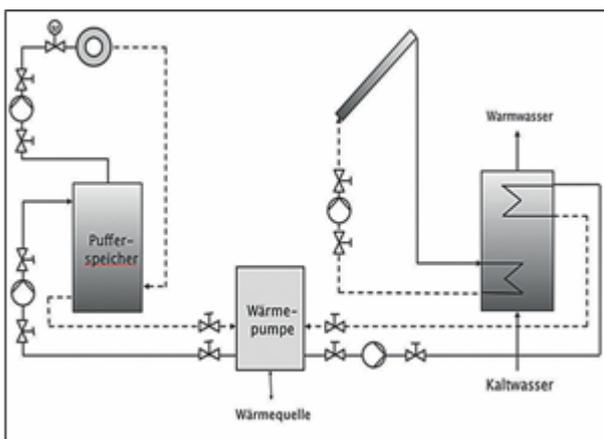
Anlagenschema einer Wärmepumpenanlage mit solarunterstützter Trinkwarmwassererwärmung
